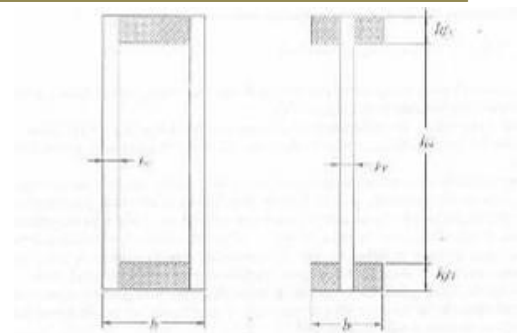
Ejemplo de viga "cajón" y viga "I" encoladas (adaptada de la referencia 1)
